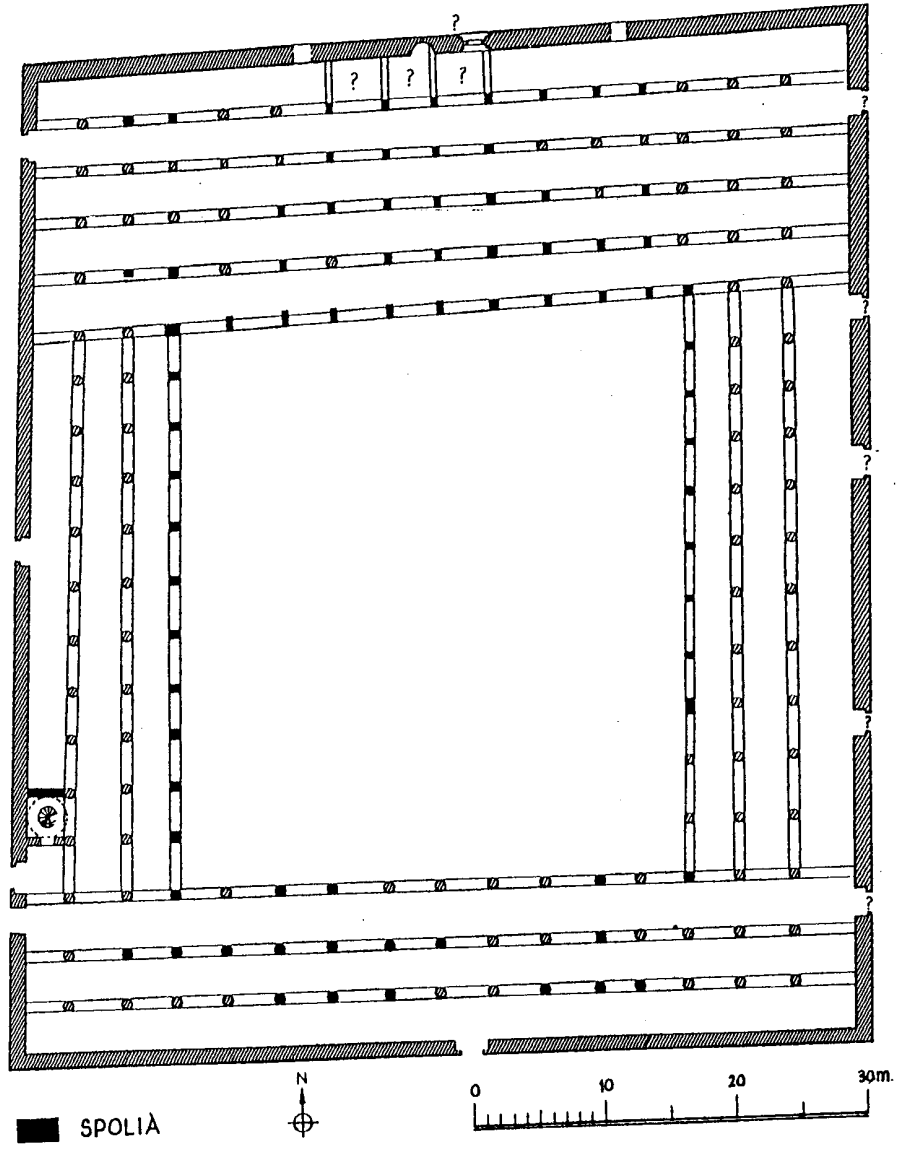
مسقط أفقي لجامع سامرا الكبير (عن : Creswell)
